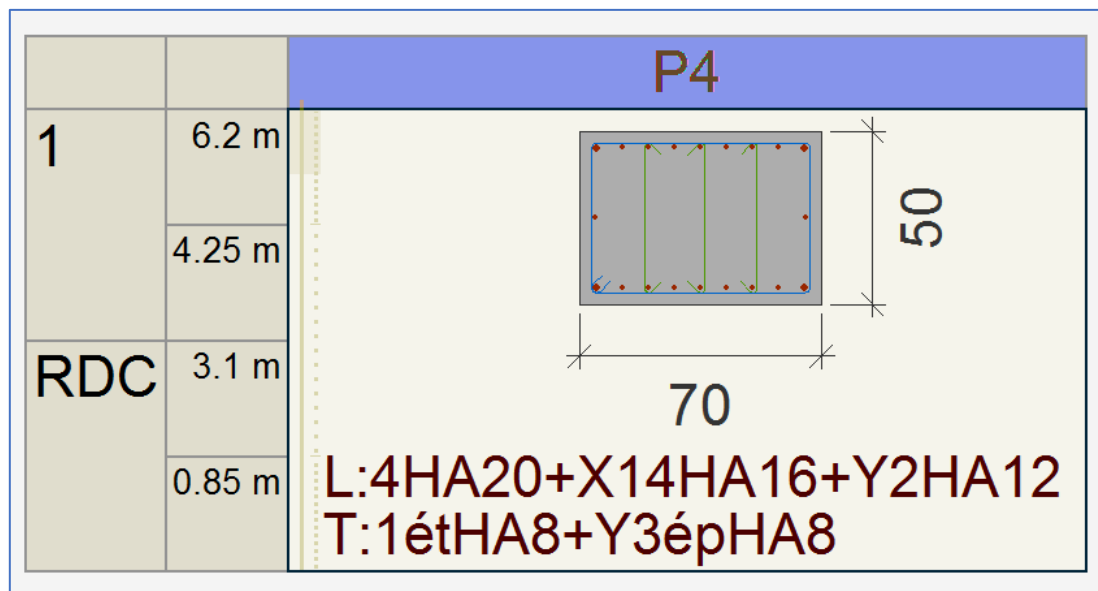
Ferrailage du poteau Pg4 sur CYPECAD, modèle du plancher dalle en BA
